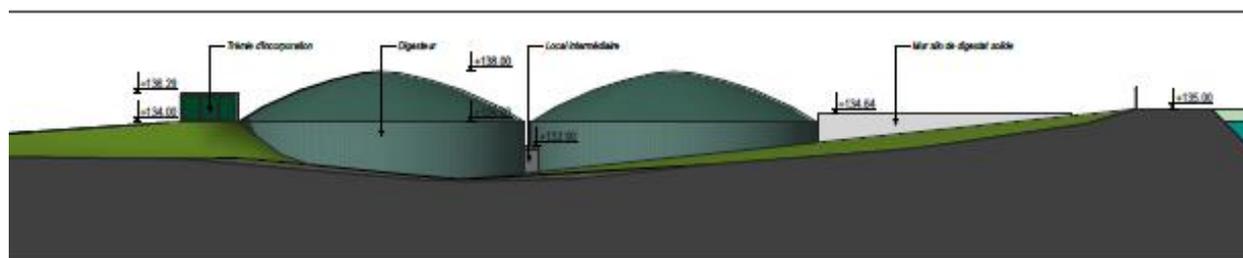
Vue en coupe sur la zone de rétention (Extrait du permis de construire)
